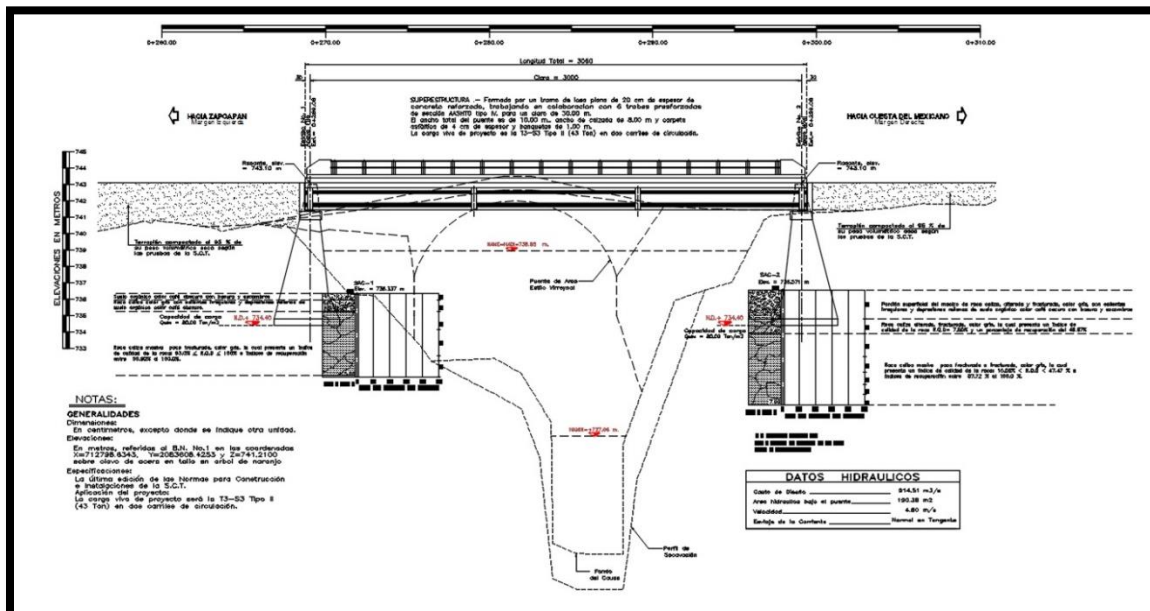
Detalles de la estructura y la profundidad de las excavaciones
